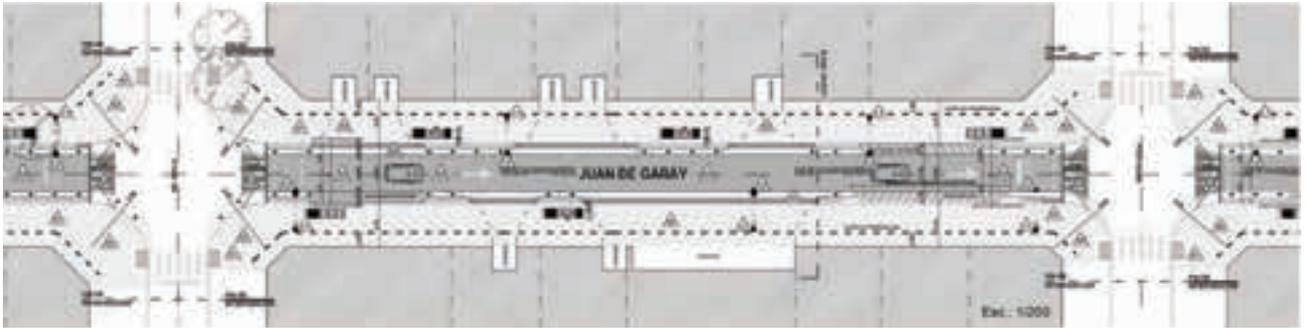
Prioridad peatón calle Cnel. Beltrán y Garay. Planta
